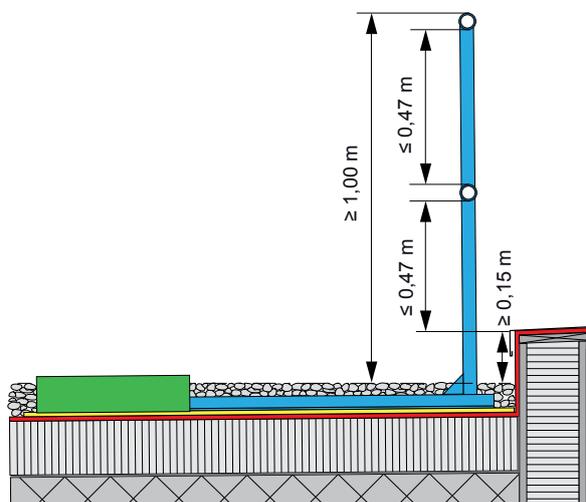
Classe d'équipement 3: système de protection latérale avec poids de retenue sur revêtement de toit plat, cotes depuis la couche d'usure/de protection
